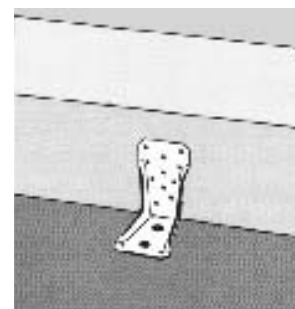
Использование гвоздей для углового соединителя KR 135 при соединении подстропильной балки
